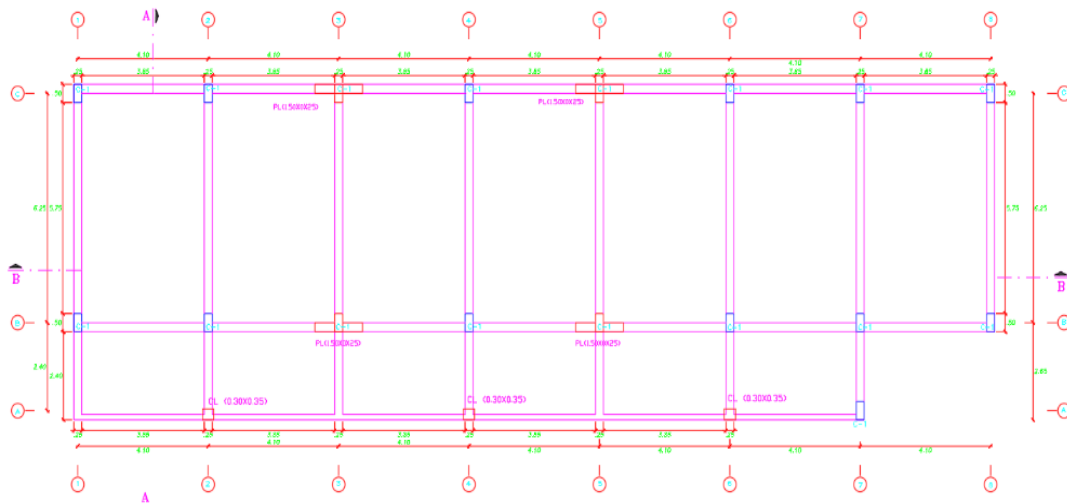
Ubicación de la placa y columna de reforzamiento- pabellón A.
